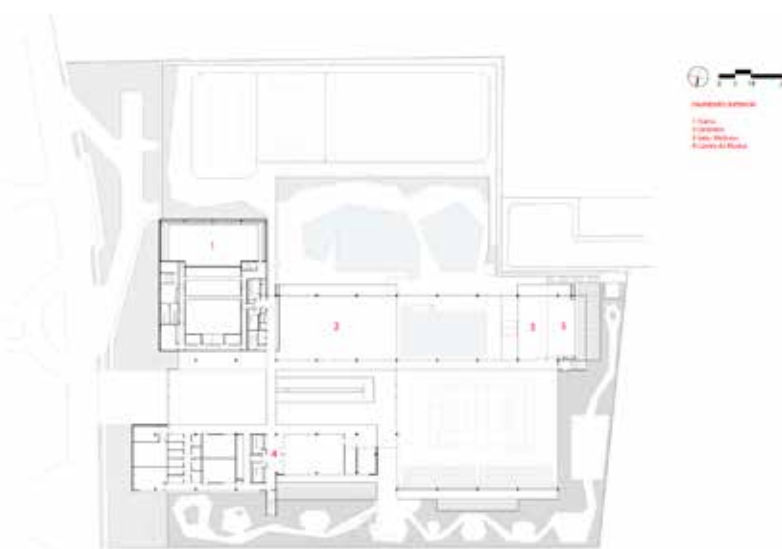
Planta pavimento superior Sesc Guarulhos.
